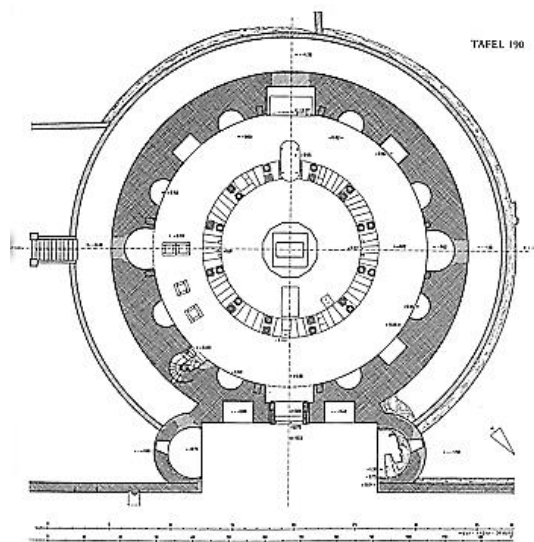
Abb. XIII: Grundriss, Rom, Mausoleum der Constantia (S. Constanza)
